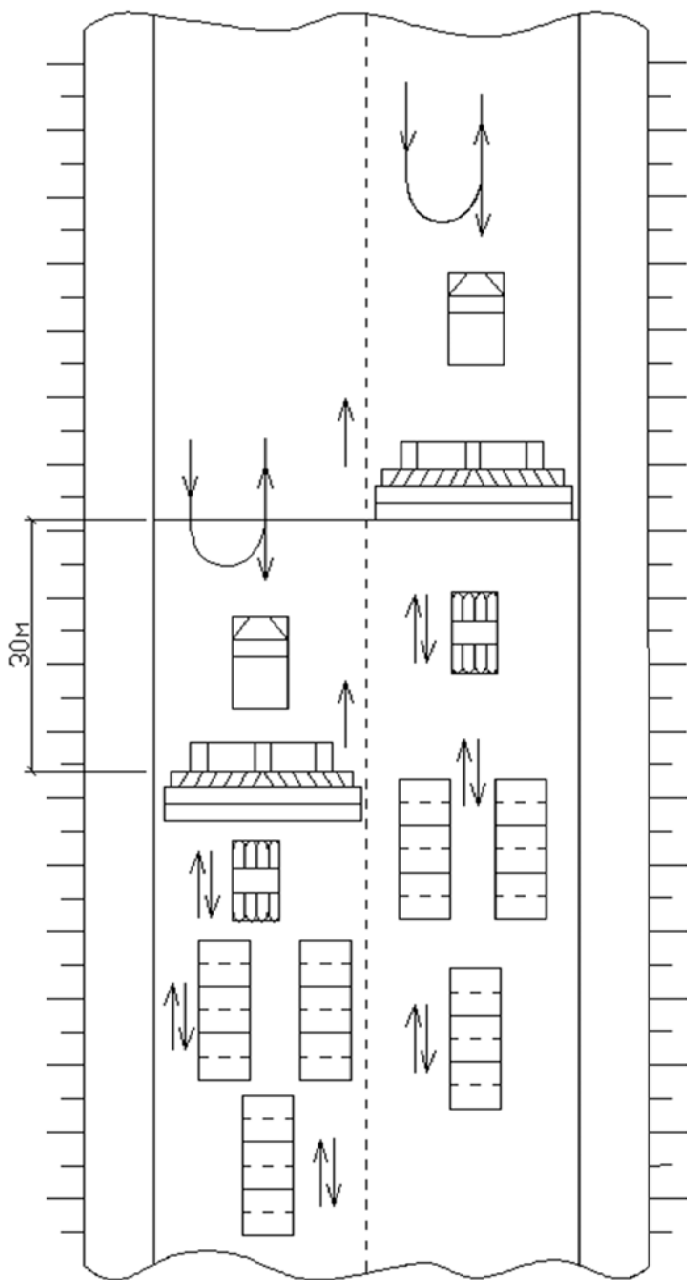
Схема укладки асфальтобетонной смеси двумя укладчиками
